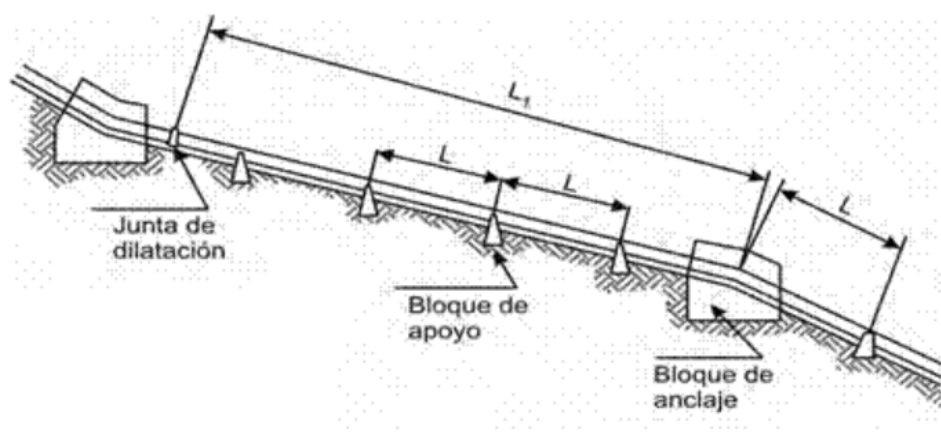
Esquema de la tubería forzada con anclajes y apoyos. Fuente [30]
